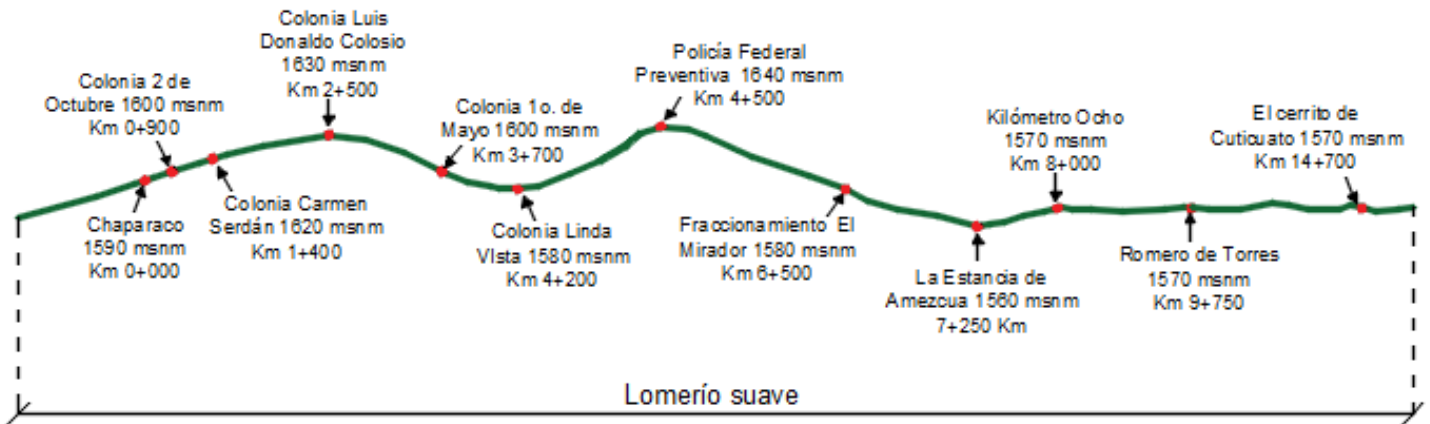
Perfil longitudinal Lib. Nte. Zam.
